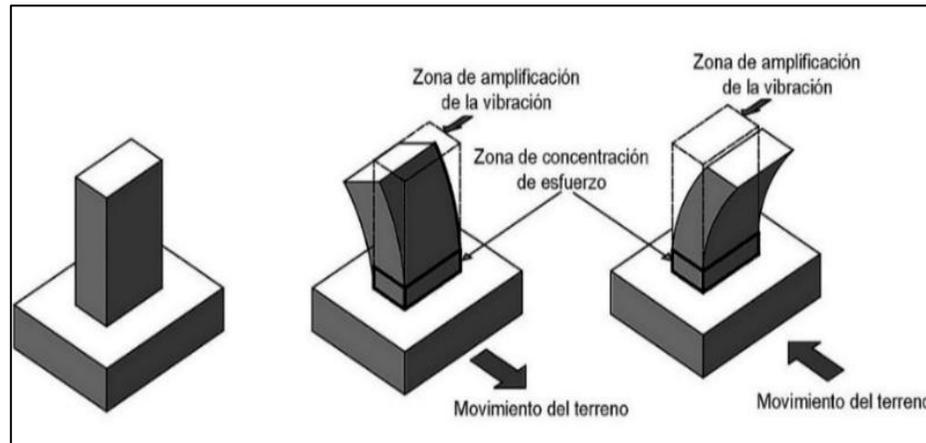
Comportamiento de una estructura por asimetría en el alzado.
